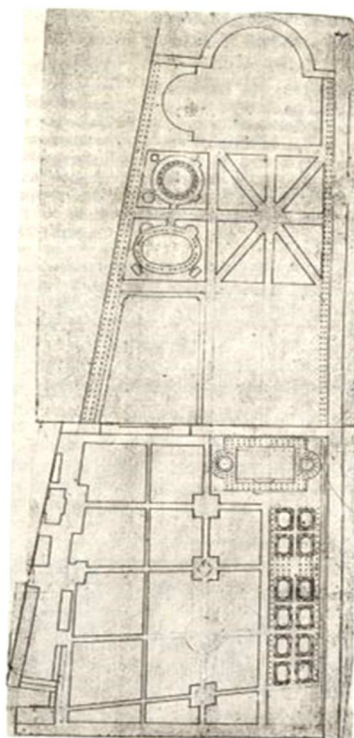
Схематический план Первого и Второго Летних садов, вычерченный Петром I в 1717 г.
